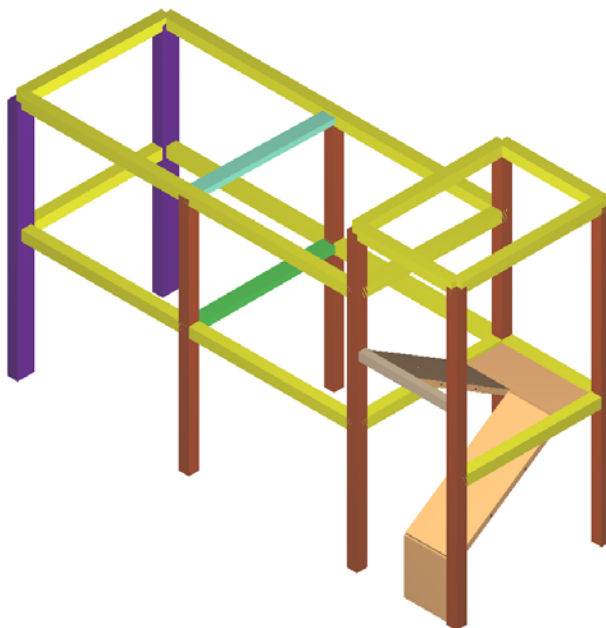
Modello agli elementi finiti – Struttura in elevazione – Vista 1
